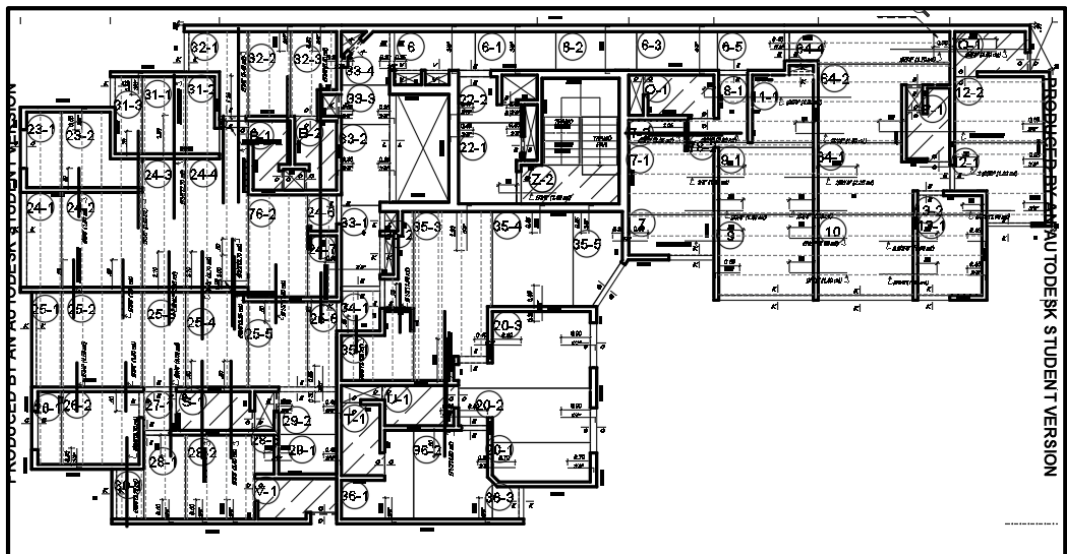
Plano de Estructuras (Prelosas) – Techo Típico
